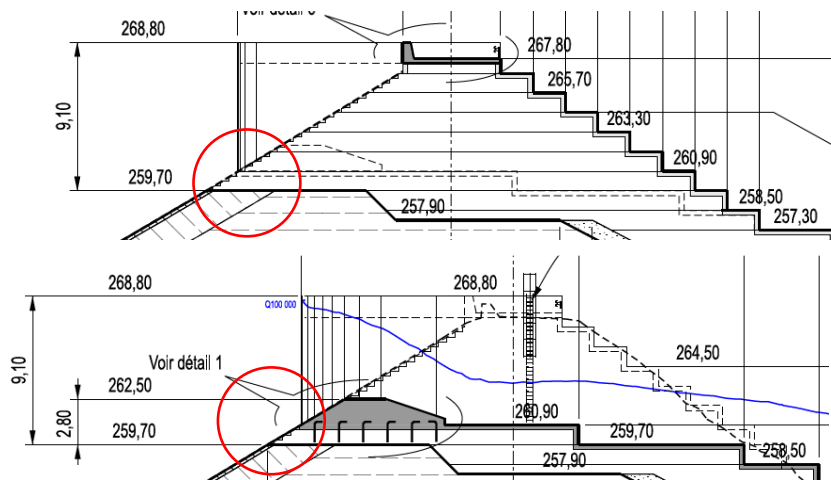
Etanchéité provisoire cote 259,70 m NGF (PROJET)
